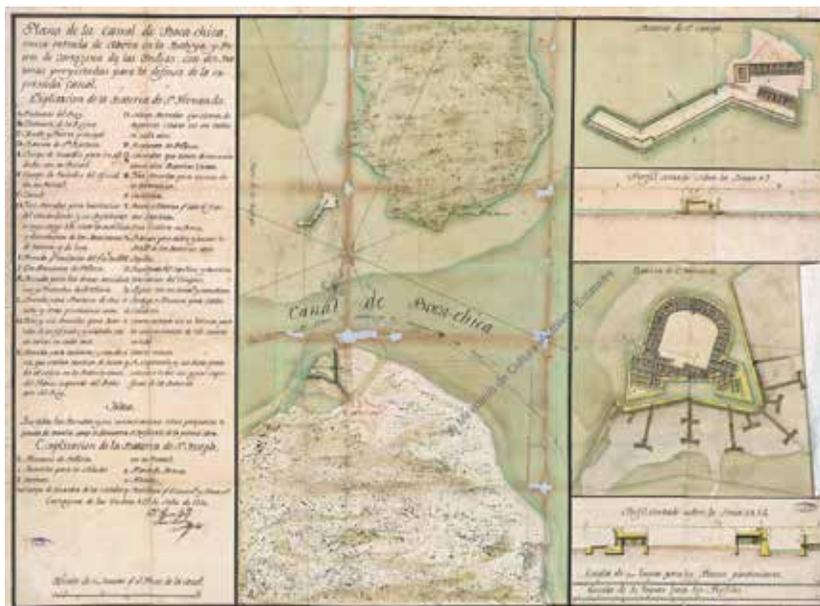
Plan del canal de Bocachica, con detalles del fuerte de San Fernando y la batería de San José, por Juan Bautista Mac Evan, 1752.
